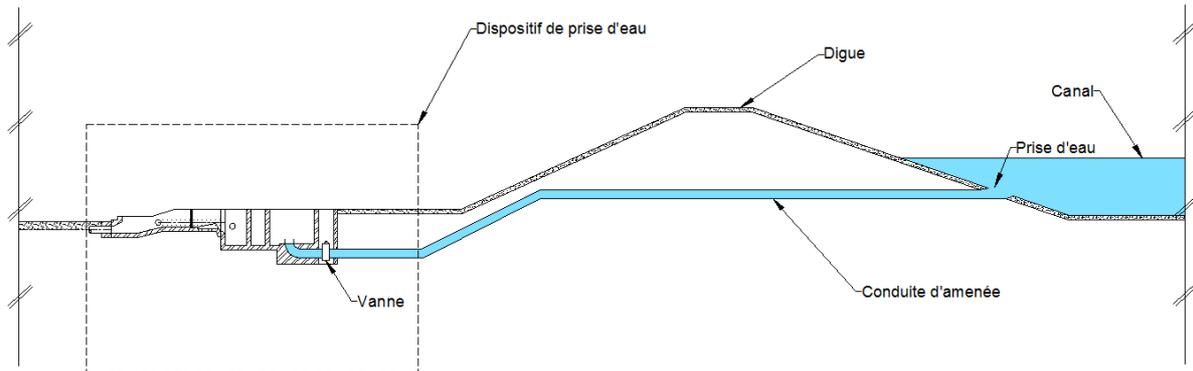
Exemple d'une coupe de canal EDF au droit d'une prise d'eau
